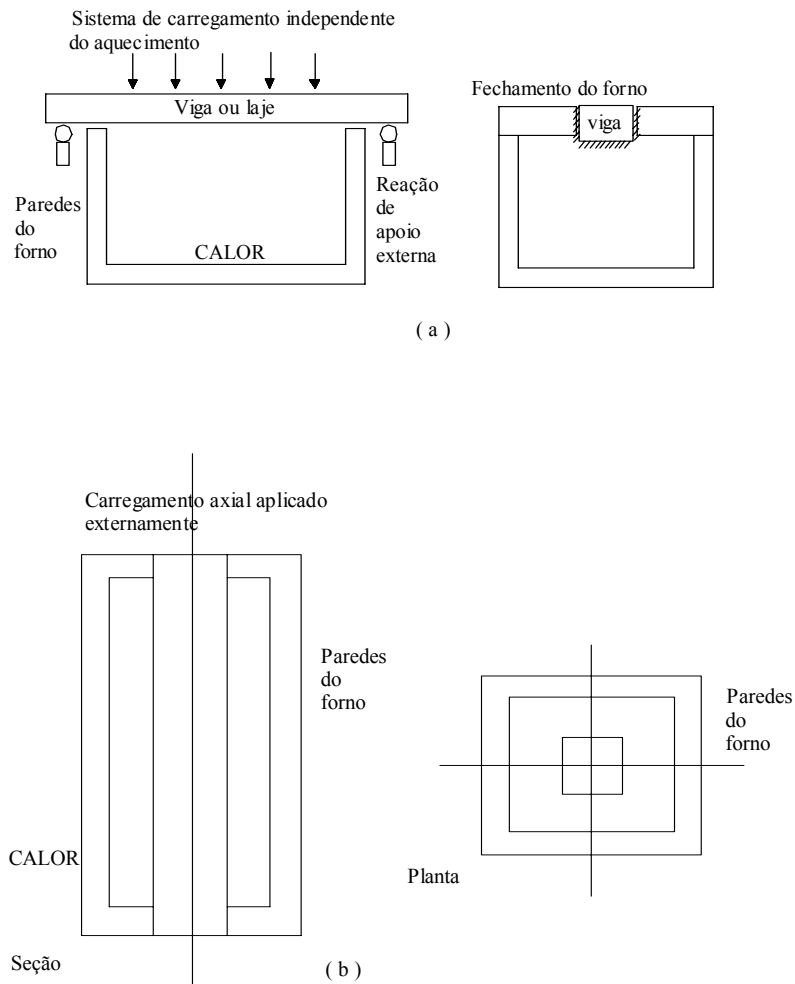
Teste do Incêndio Padrão: a) Vigas e b) Pilares
